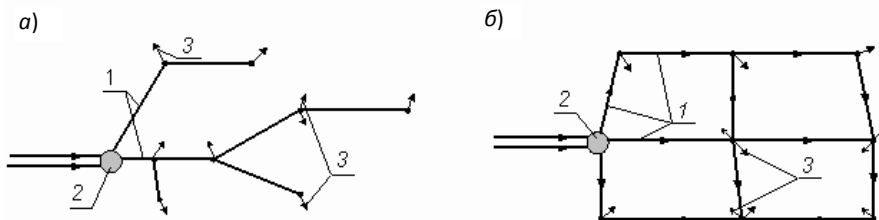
Схемы начертания водопроводных сетей:
